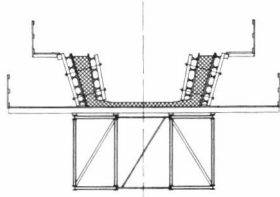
Querschnitte Pfeiler und Überbau – Coupe en travers du pilier et de la superstructure – Cross section of pier and superstructure
